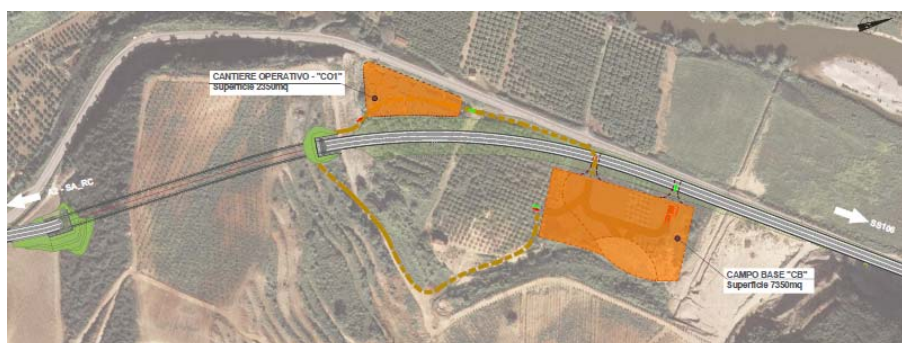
Stralcio planimetrico tratto 2 con ubicazione del cantiere operativo CO1 e del campo base CB.
